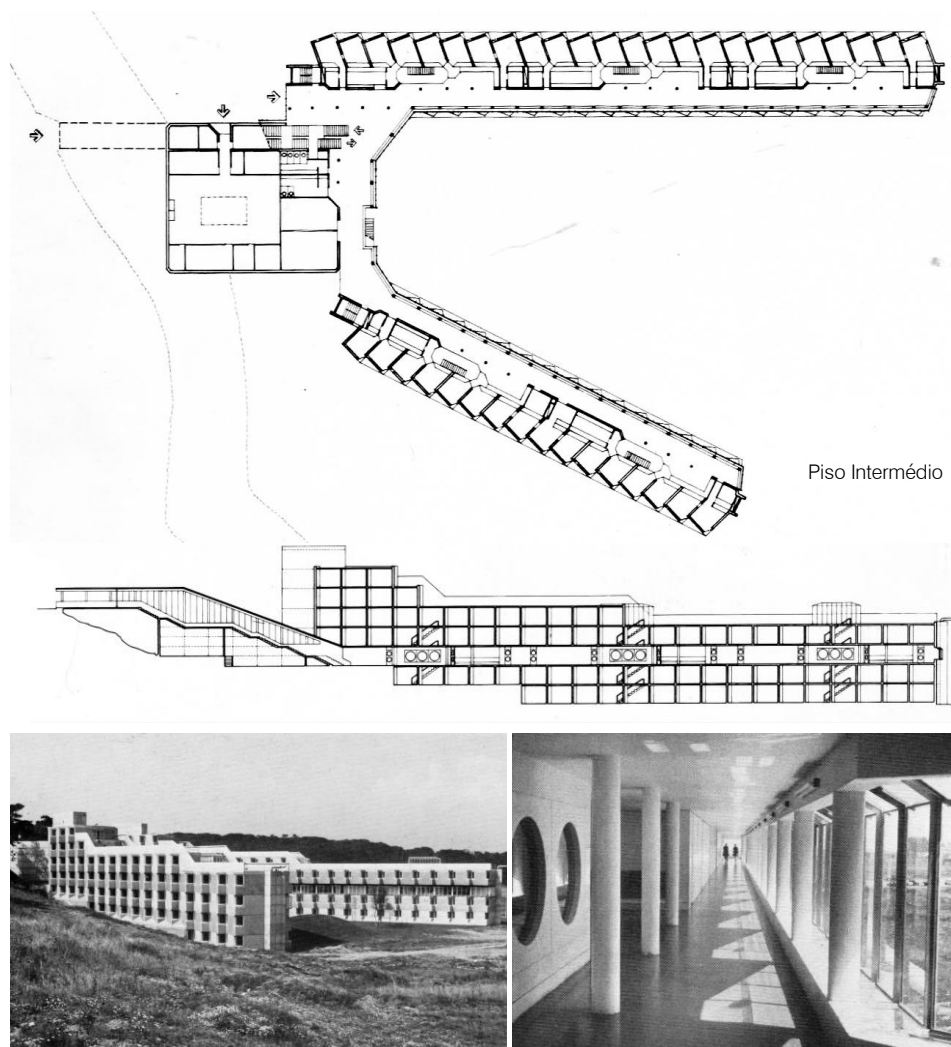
Planta do piso 2 (Desenho da autora)
